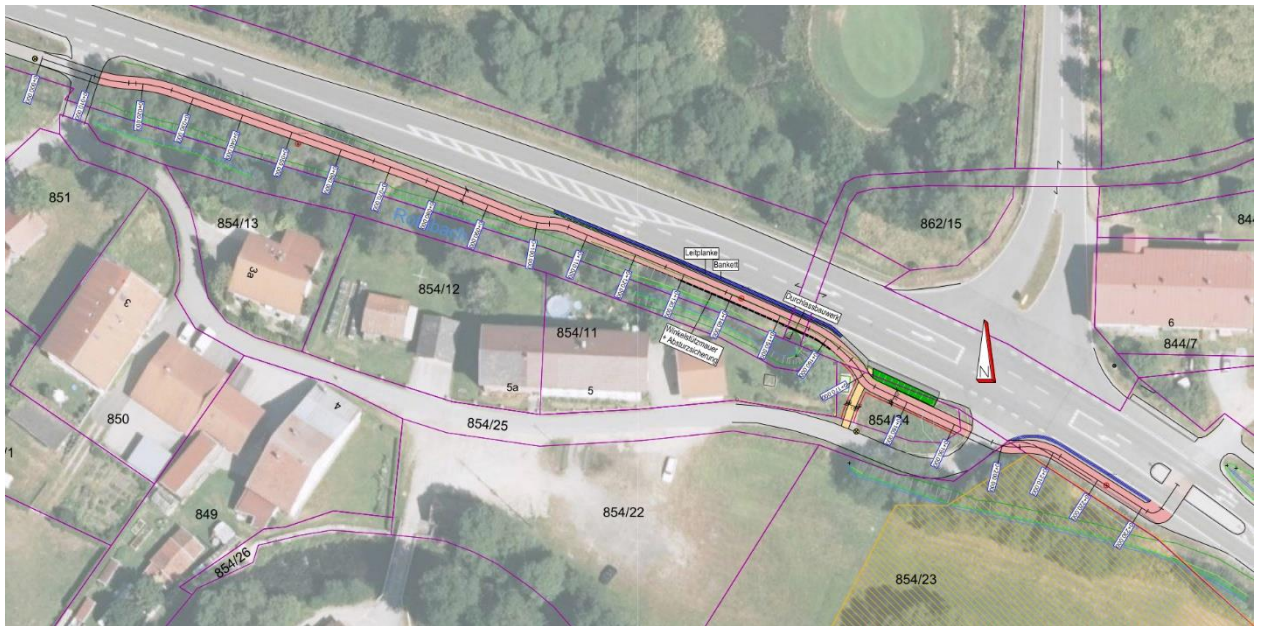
Lageplan zur Baumaßnahmen (Quelle IB Kiendl & Moosbauer, Stand 11/2024)
